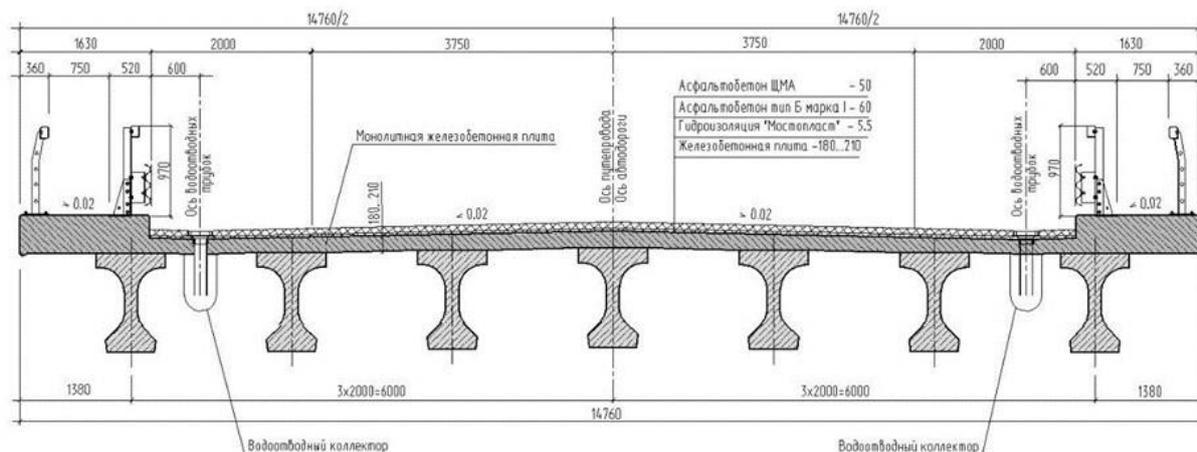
Предлагаемая конструкция пролётного строения из сборных железобетонных балок
